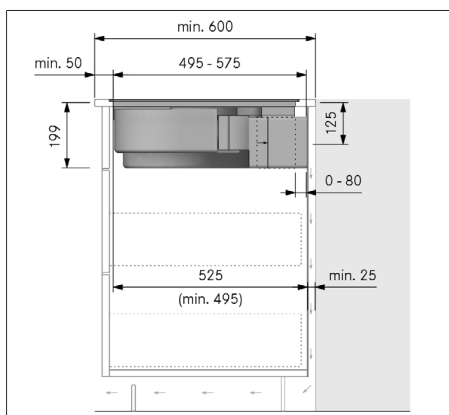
Medidas de montagem para a circulação de ar, variante de montagem A
